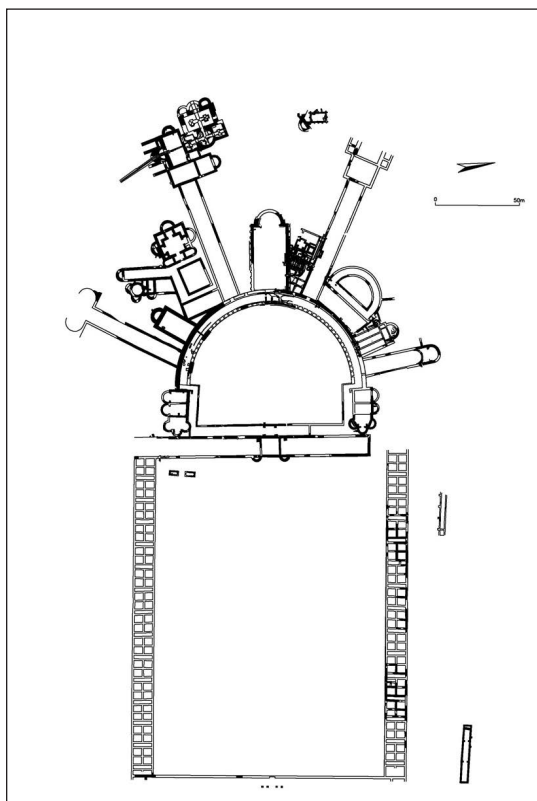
Planta del complejo arquitectónico de Cercadilla.
